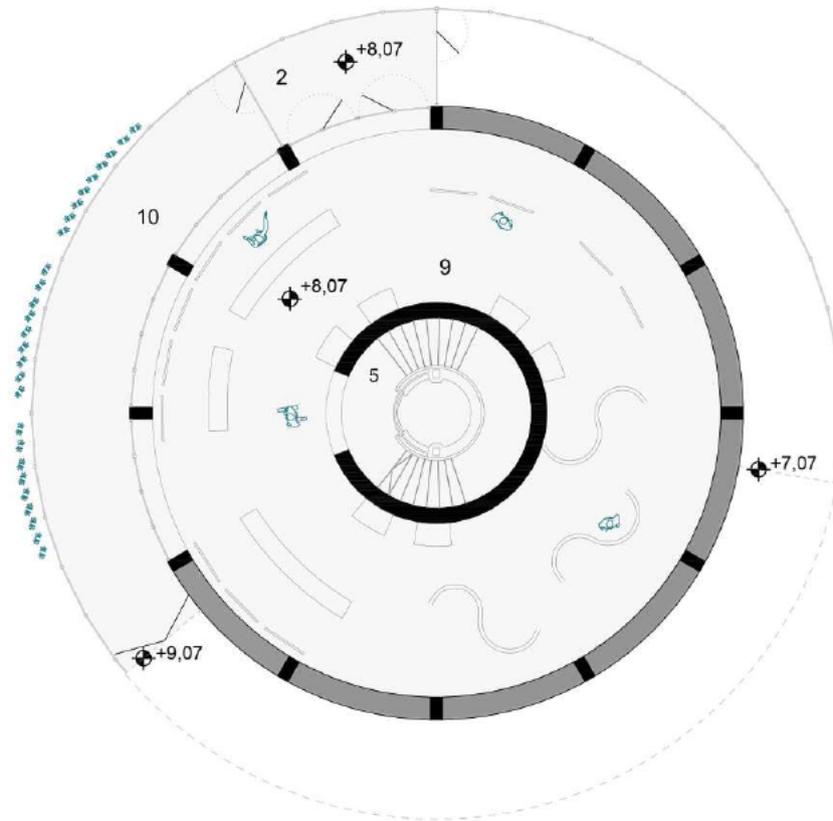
Grundriss Erdgeschoss
